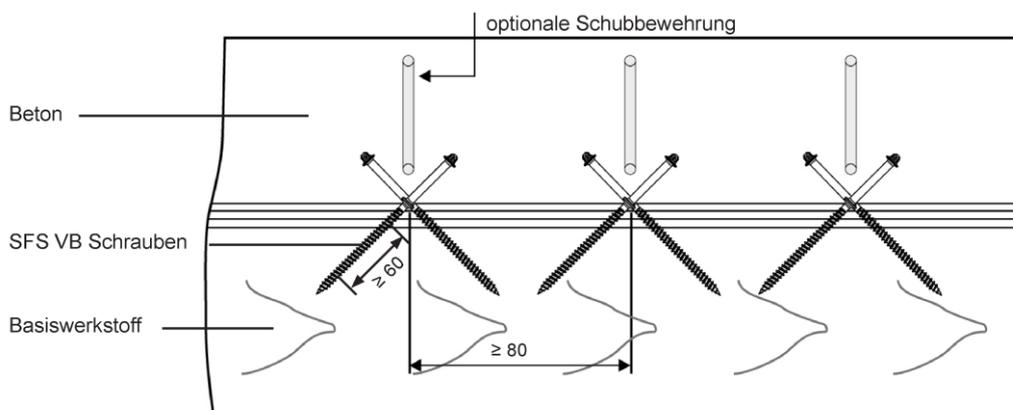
Prinzipielle Ansicht einer Holz-Beton-Verbundkonstruktion mit SFS VB Schrauben
